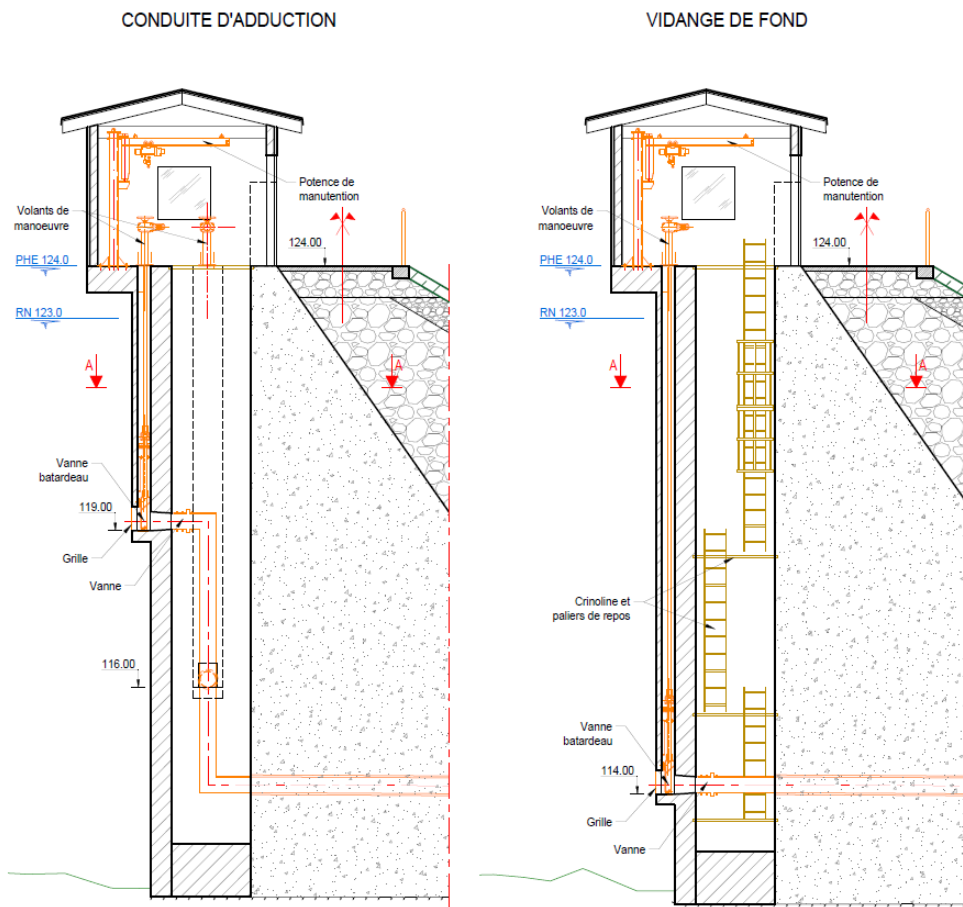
Coupes verticales de la tour de prise d'eau Plan « PRISE 02 » du dossier de plans
